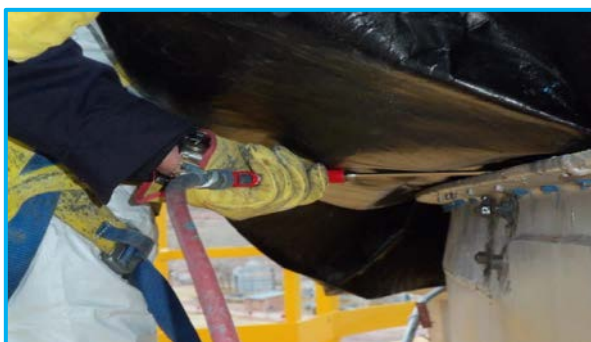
Aplicación de aire a presión sobre la Zona de Unión No. 1 - Vista desde el lado exterior del tanque.
